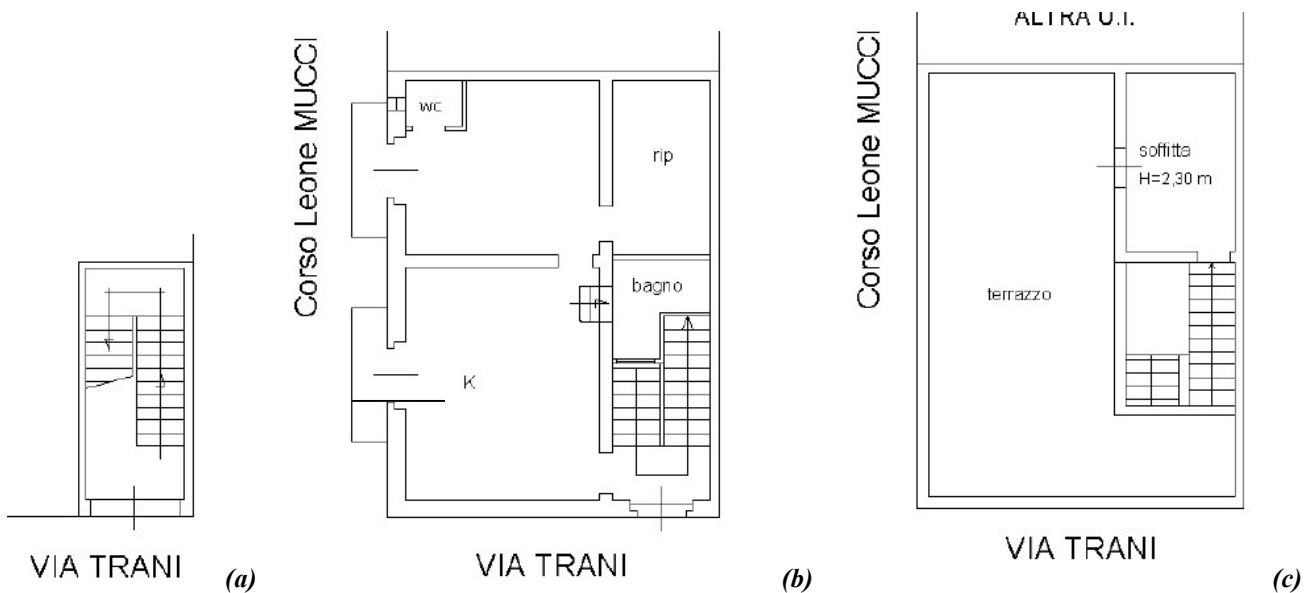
Planimetrie catastali dell'immobile ubicato in via Trani n° 4: piano terra (a); primo piano (b); secondo piano (c).
